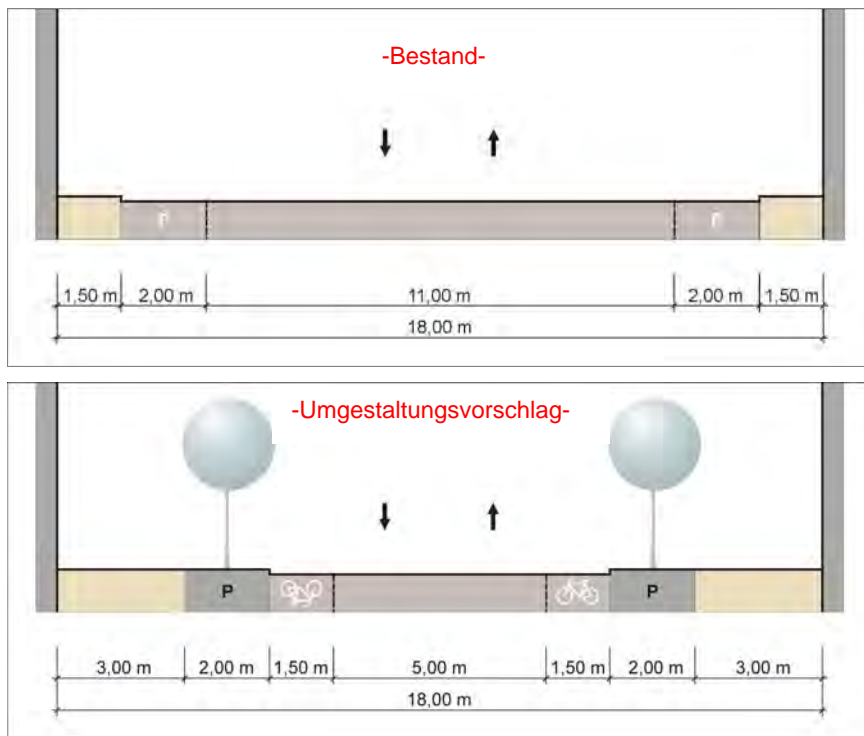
Münchener Straße – Abschnitt Samerstraße/Lutipoldstraße
